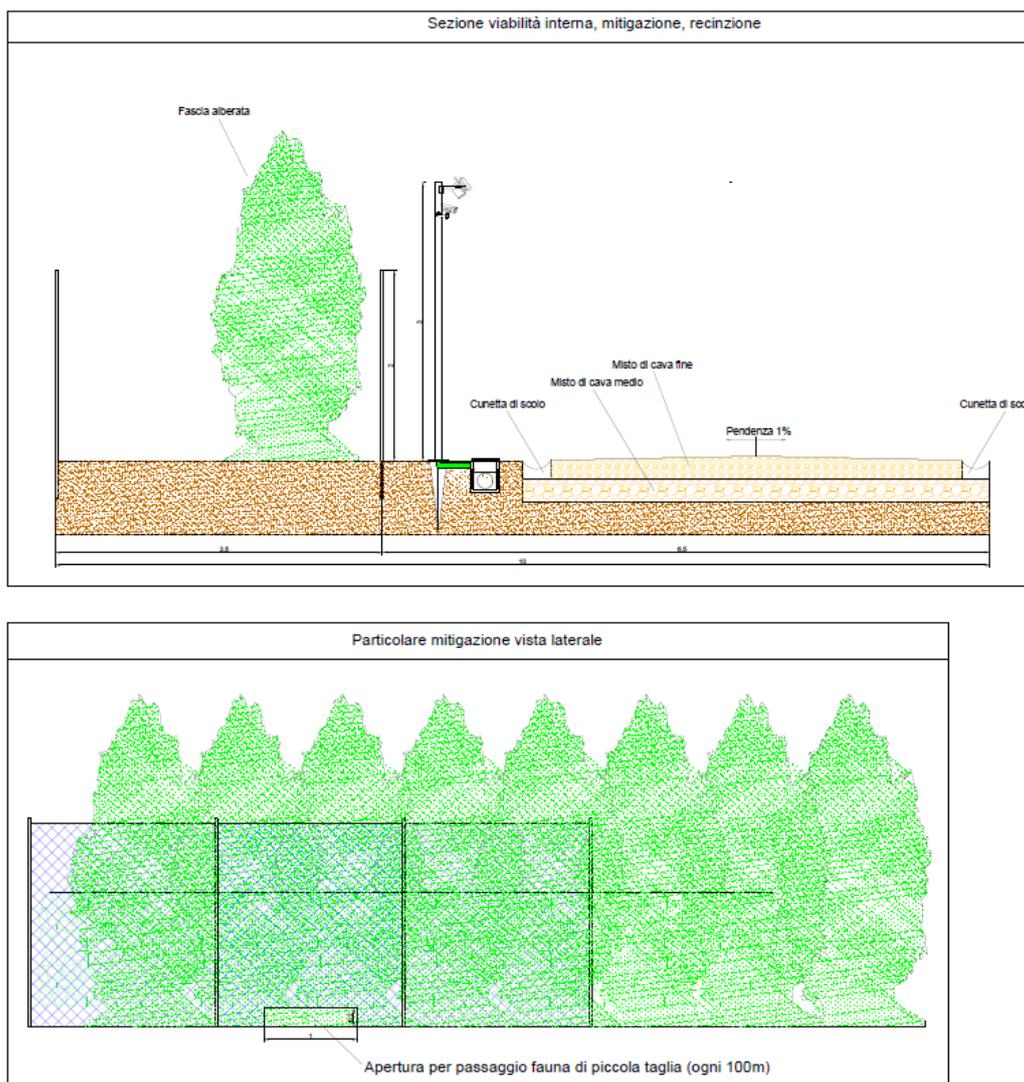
Mitigazioni paesaggistica, sezione e vista laterale delle sistemazioni a verde.
